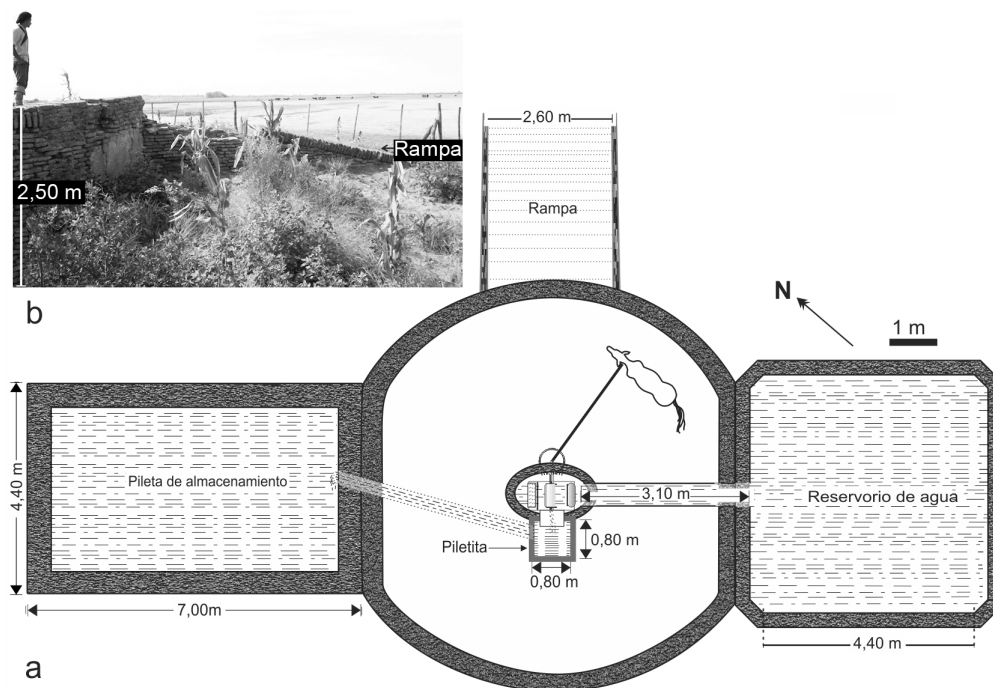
a: Emplazamiento de la noria vista en planta; b: Fotografía lateral de la rampa.
